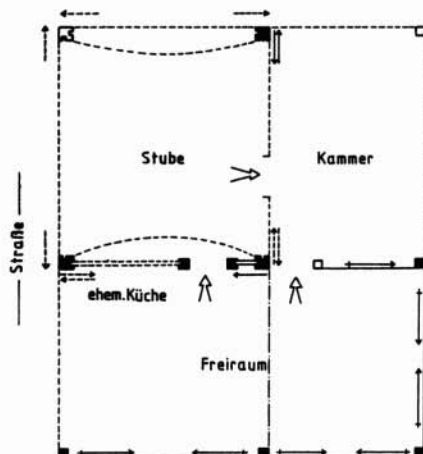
Ravensburg, Roßbachstraße 14 (1484 d), Systemgrundriß erster Oberstock.
